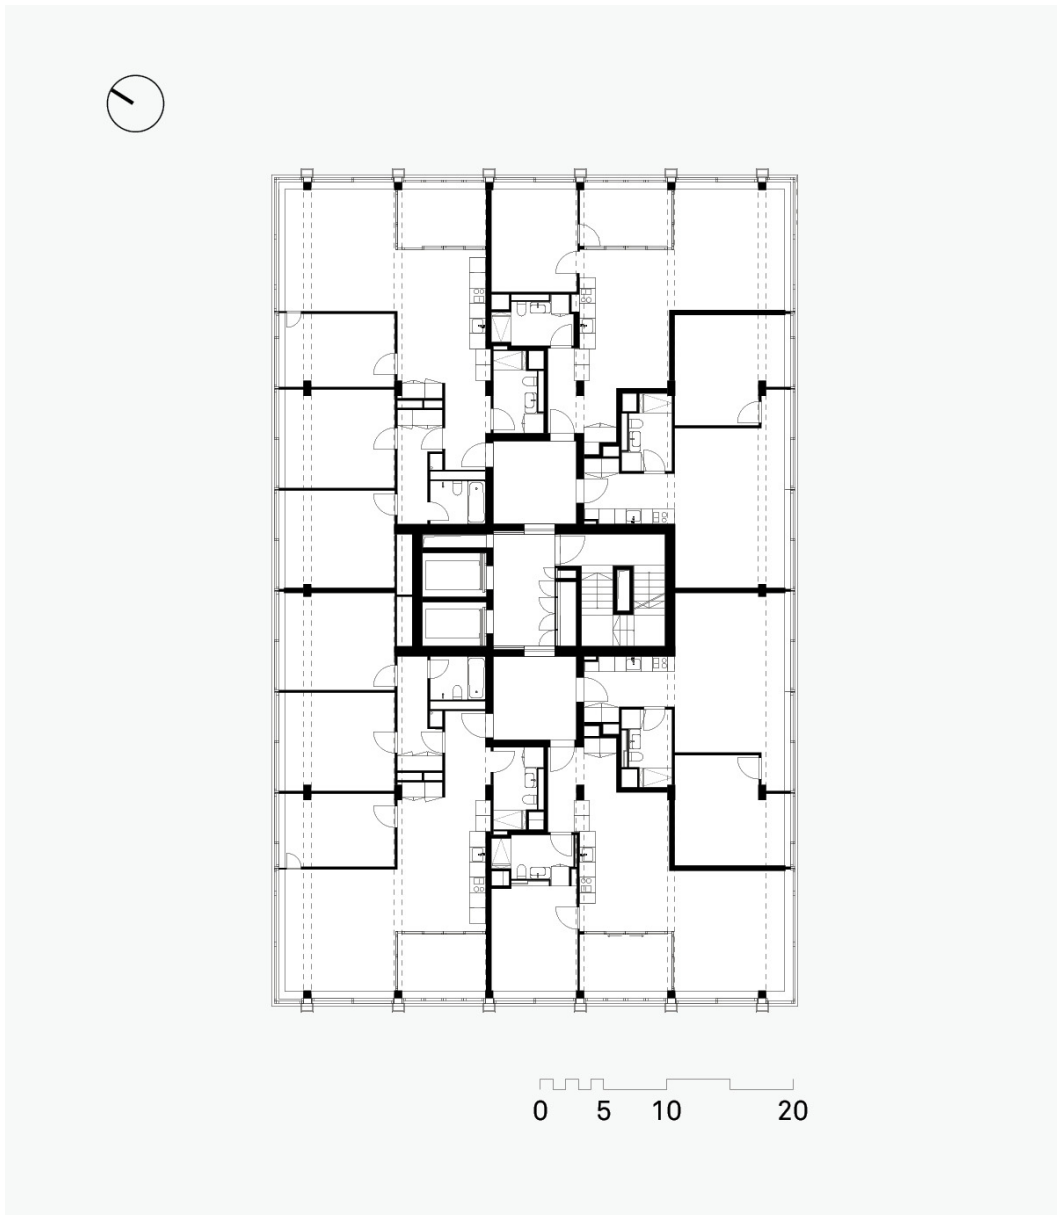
Grundriss Regelgeschoss 6. OG
